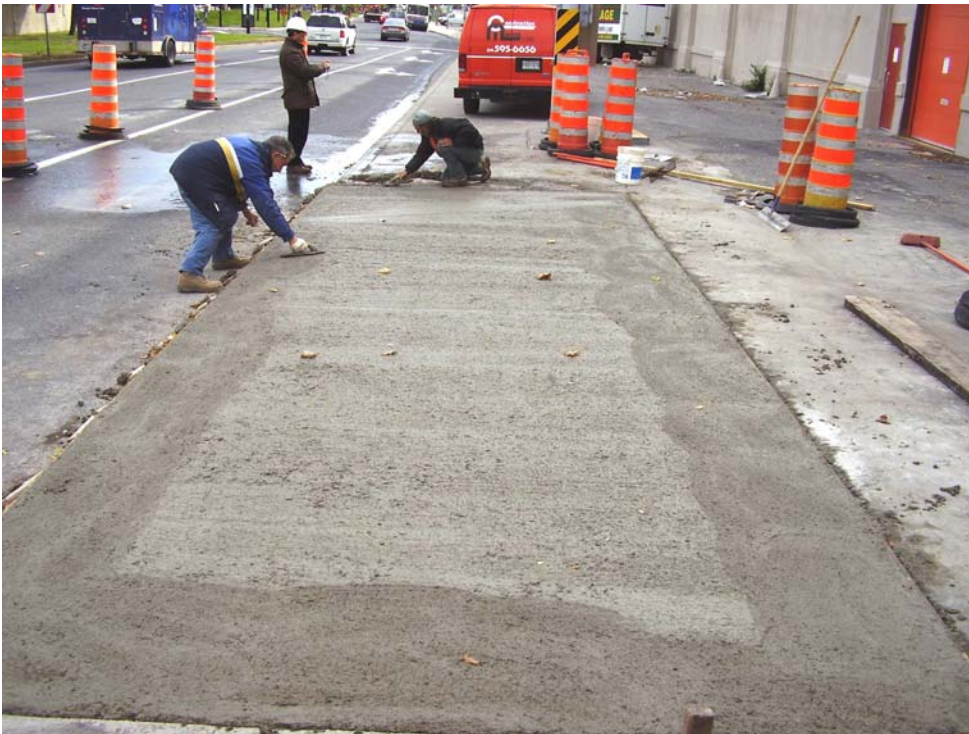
Travaux de réfection. Mise en place de béton pour la reconstruction du trottoir (tranchée 07E142-47) sur la rue Nazareth, au nord de la rue William.
